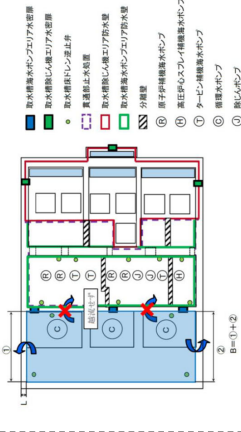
取水槽海水ポンプエリア平面図 (循環水系配管破損時)
